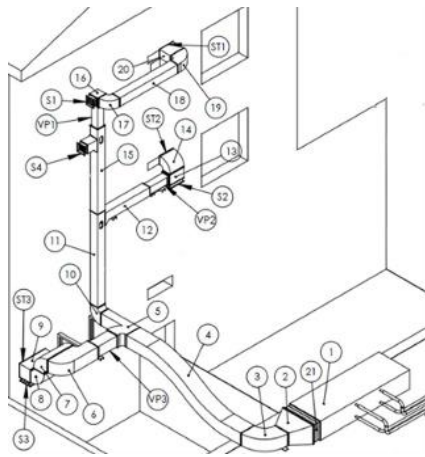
Installazione Energy Box – Firenze – sistema HVAC
